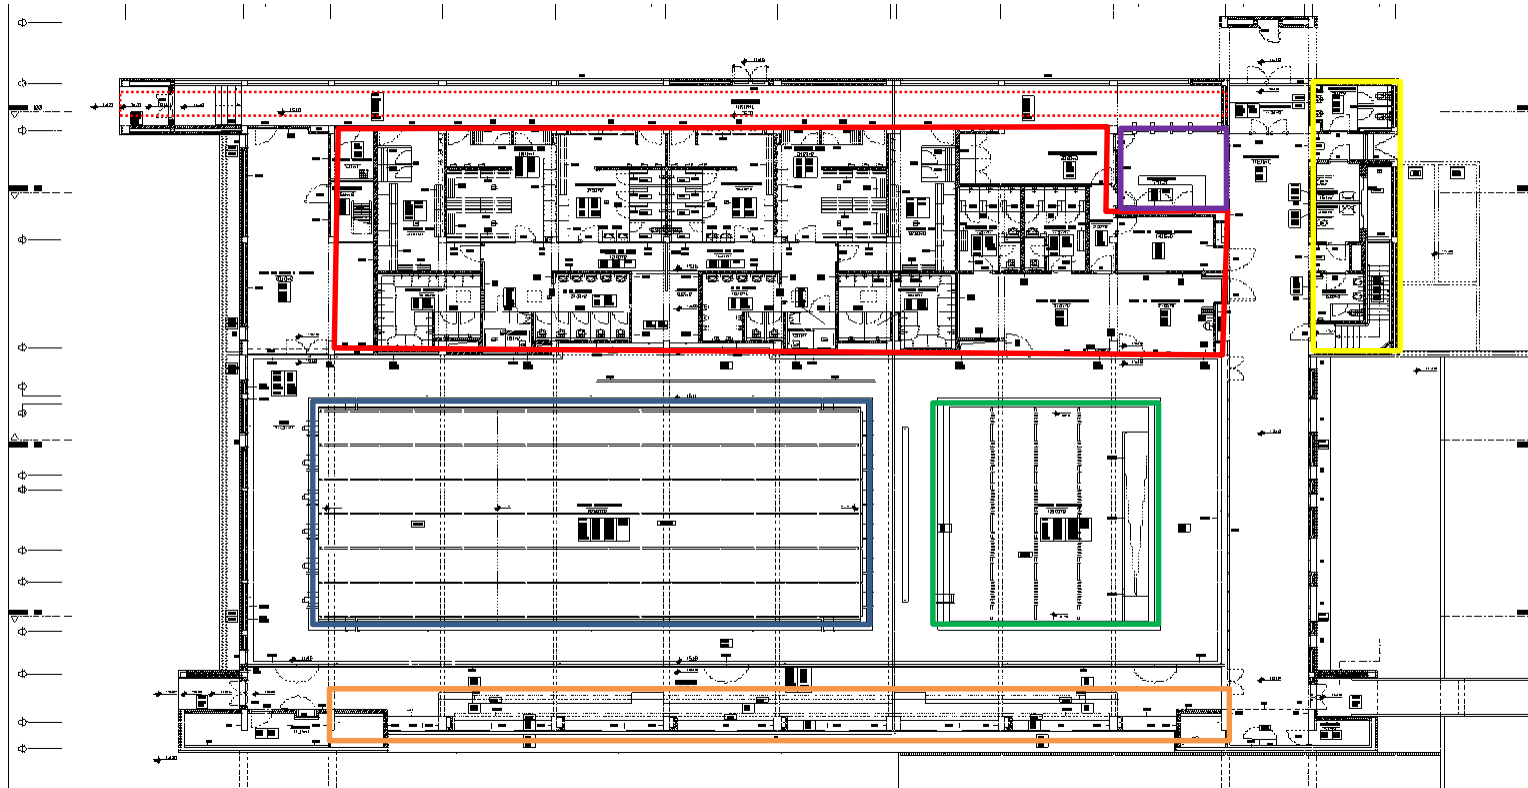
Planta Piso 0. Fonte: Projeto de arquitetura.
